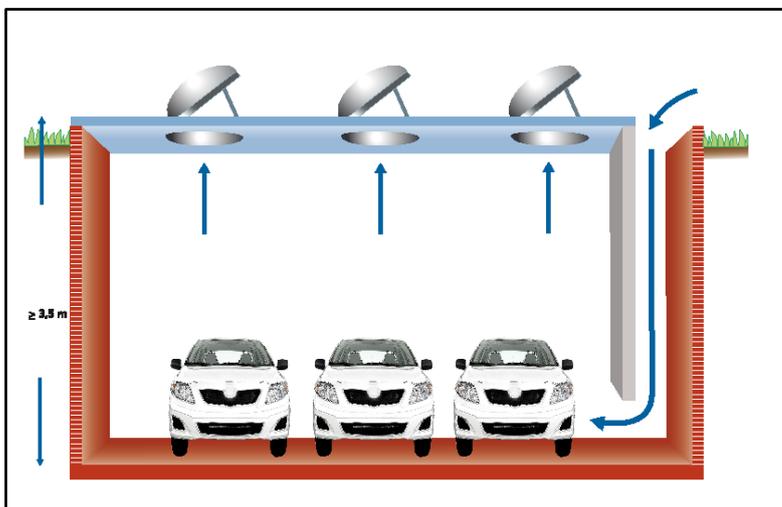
Unterirdische Garage mit NRA im Dach eingebaut
